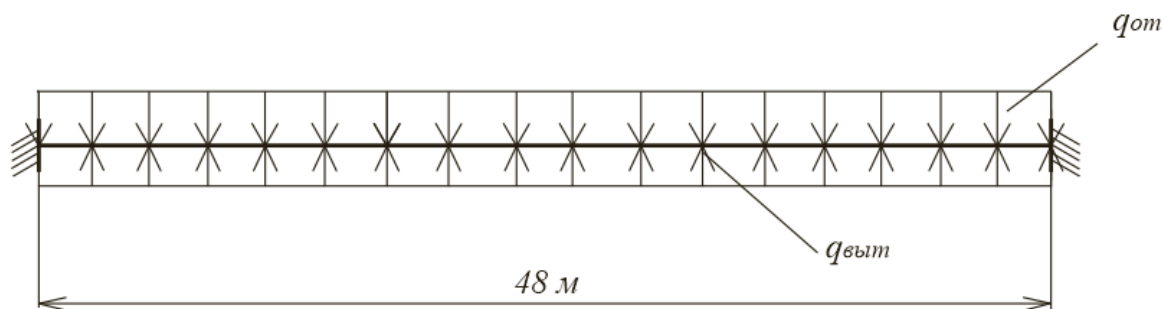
Расчетная схема трубопровода со сплошным обетонированием
